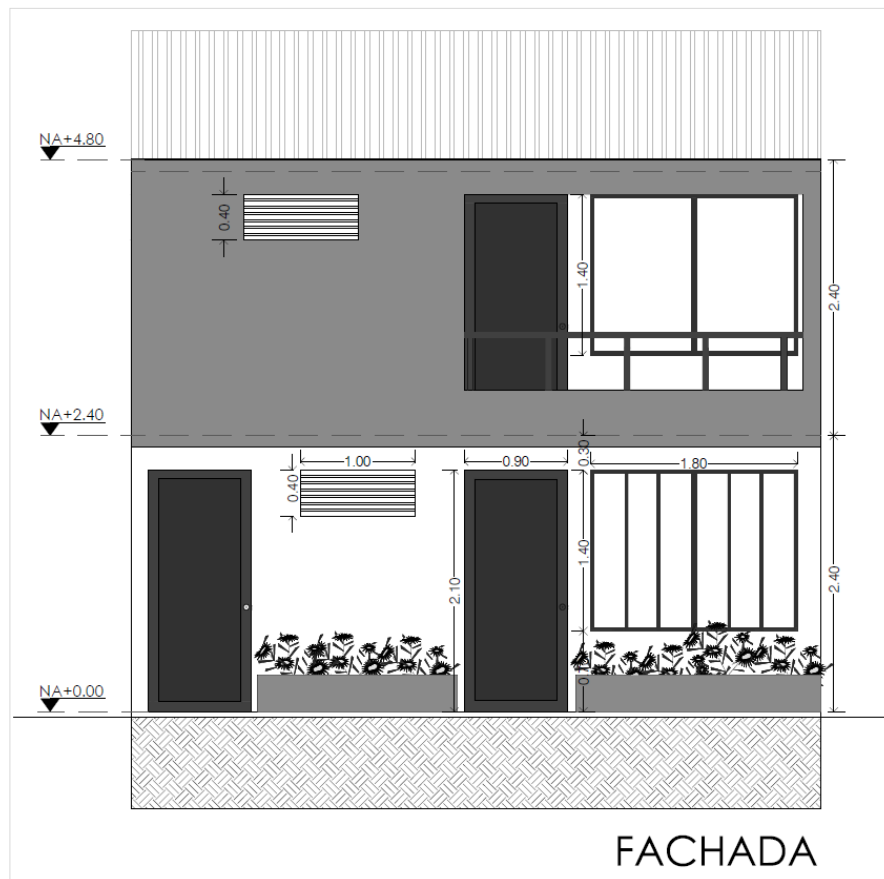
Fachada de vivienda bifamiliar tipo. Fuente: Autores.
